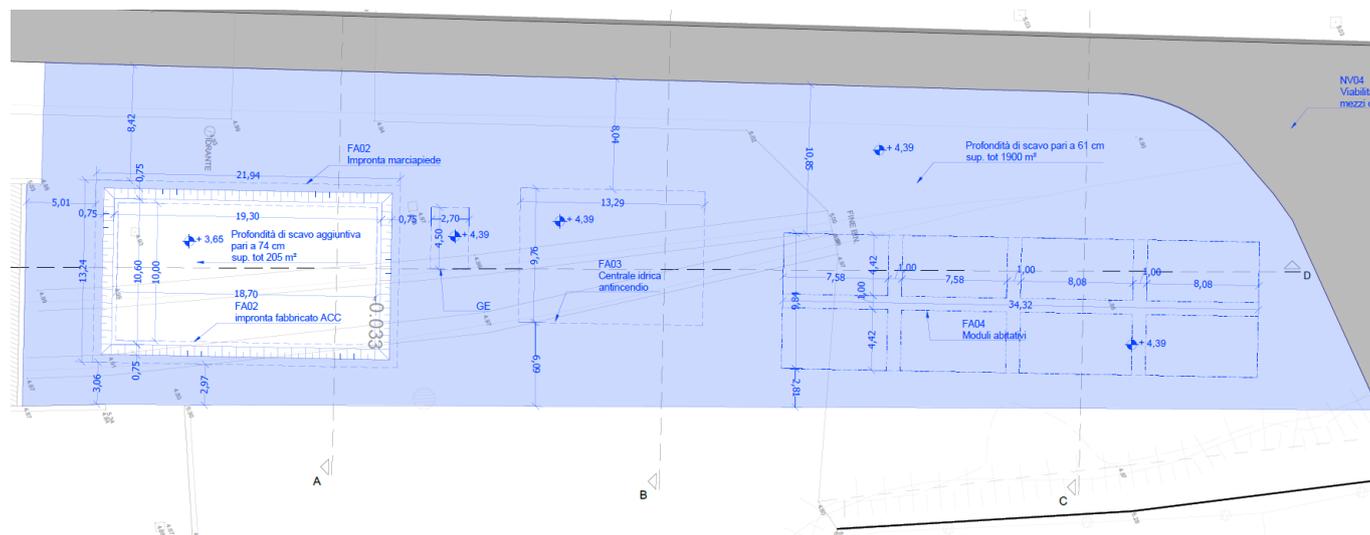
FA02 e relativo piazzale esterno – Pianta Scavi
